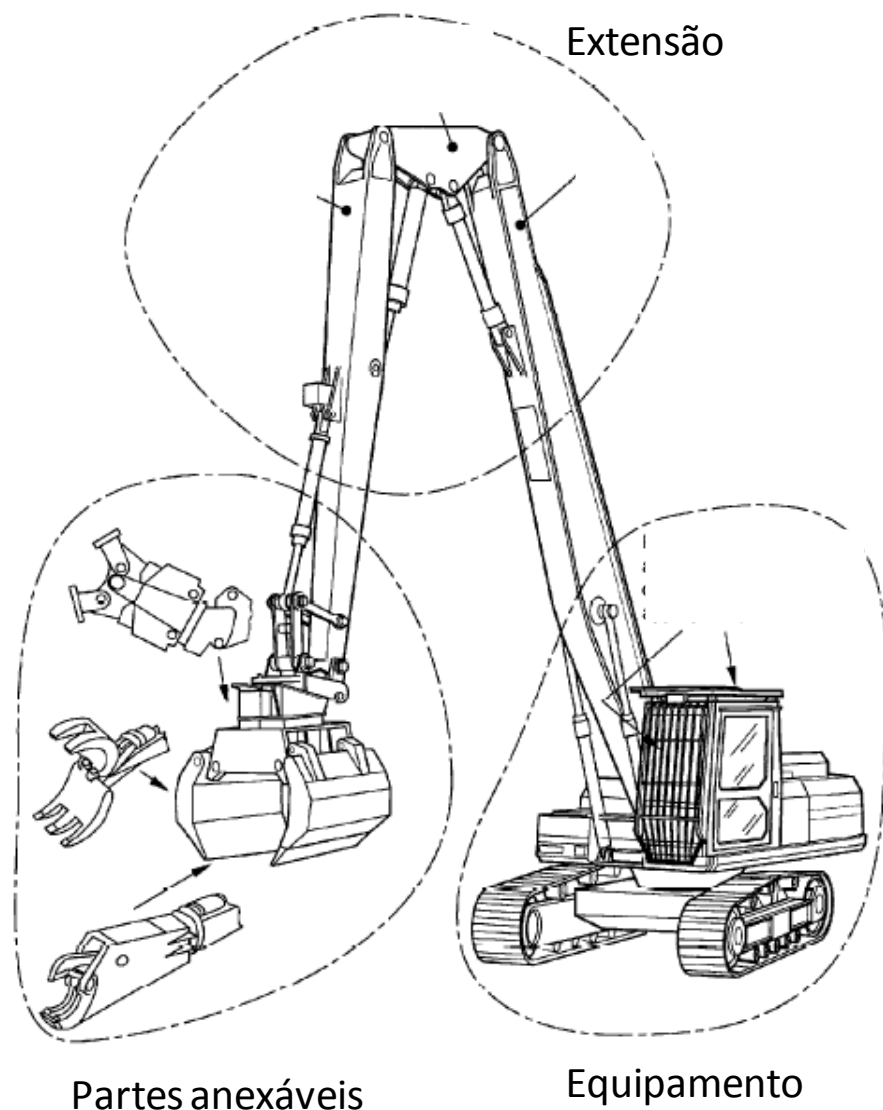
Peças de encaixe nas escavadeiras para fragmentação e corte de peças de concreto armado.
